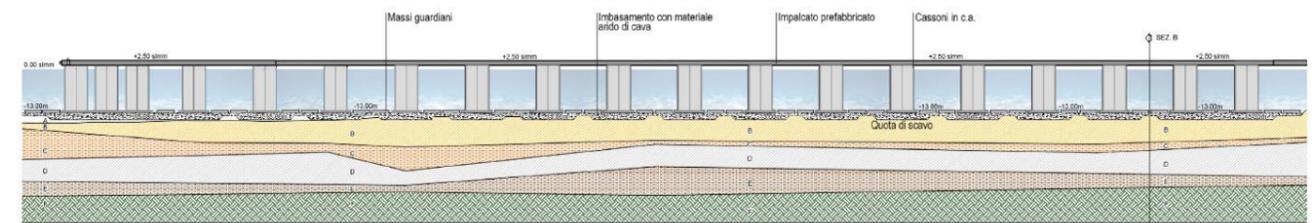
SEZIONE LONGITUDINALE DI PROGETTO
